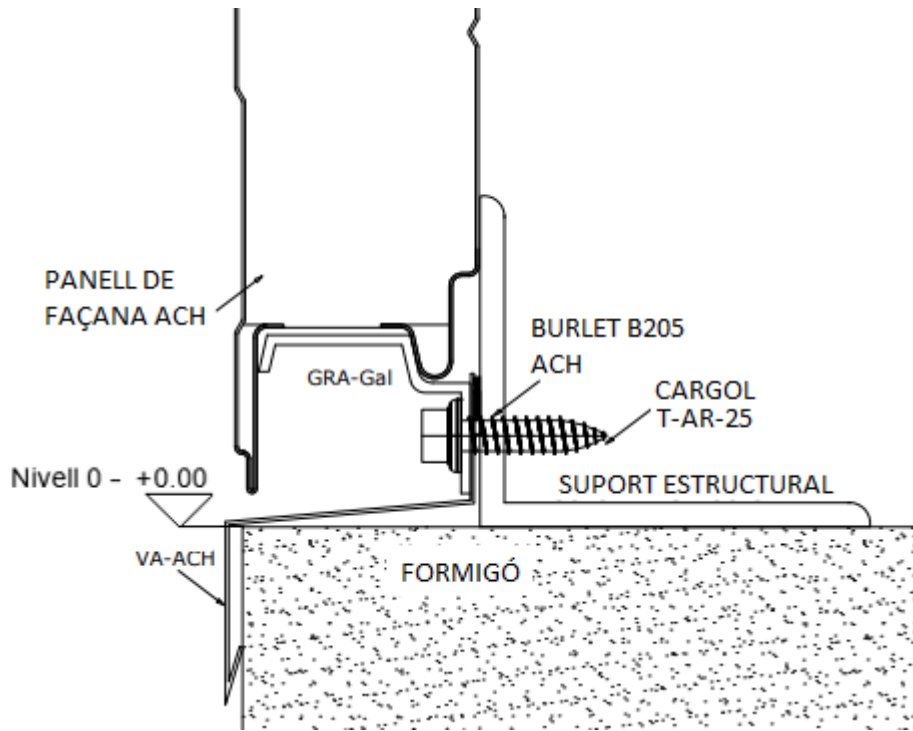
Detall recolzament del tancament metàl·lic al nivell de cota 0. (Font: "Paneles Ach" [37])
